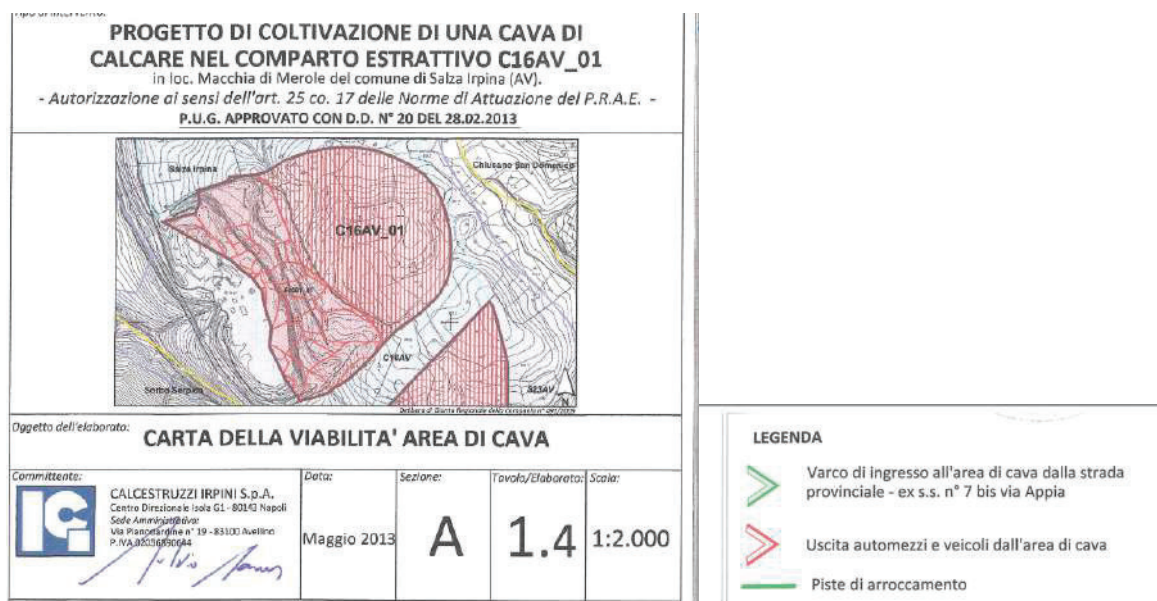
Stralcio Allegato 08 G.C. 24/06/25
